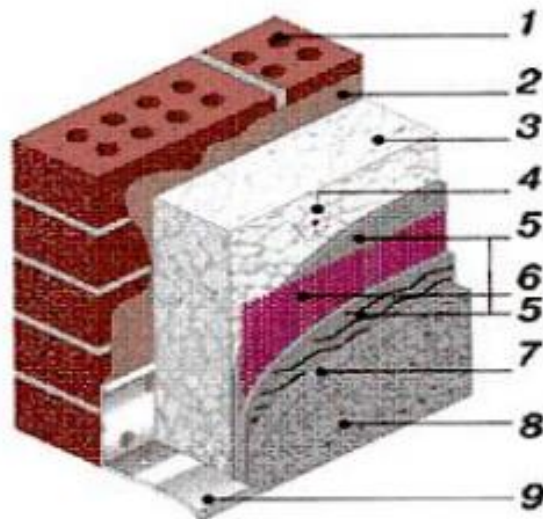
Схема утеплення стін на основі метода скріпленої теплоізоляції: 1 – будівельна основа; 2 – суміш для приклеювання плит; 3 – утеплювач; 4 – крипіжний дюбель; 5 – клеєва суміш; 6 – скловолокняна армуюча пливка; 7– ґрунтовка; 8 – декоративний шар; 9 – цокольний профіль
